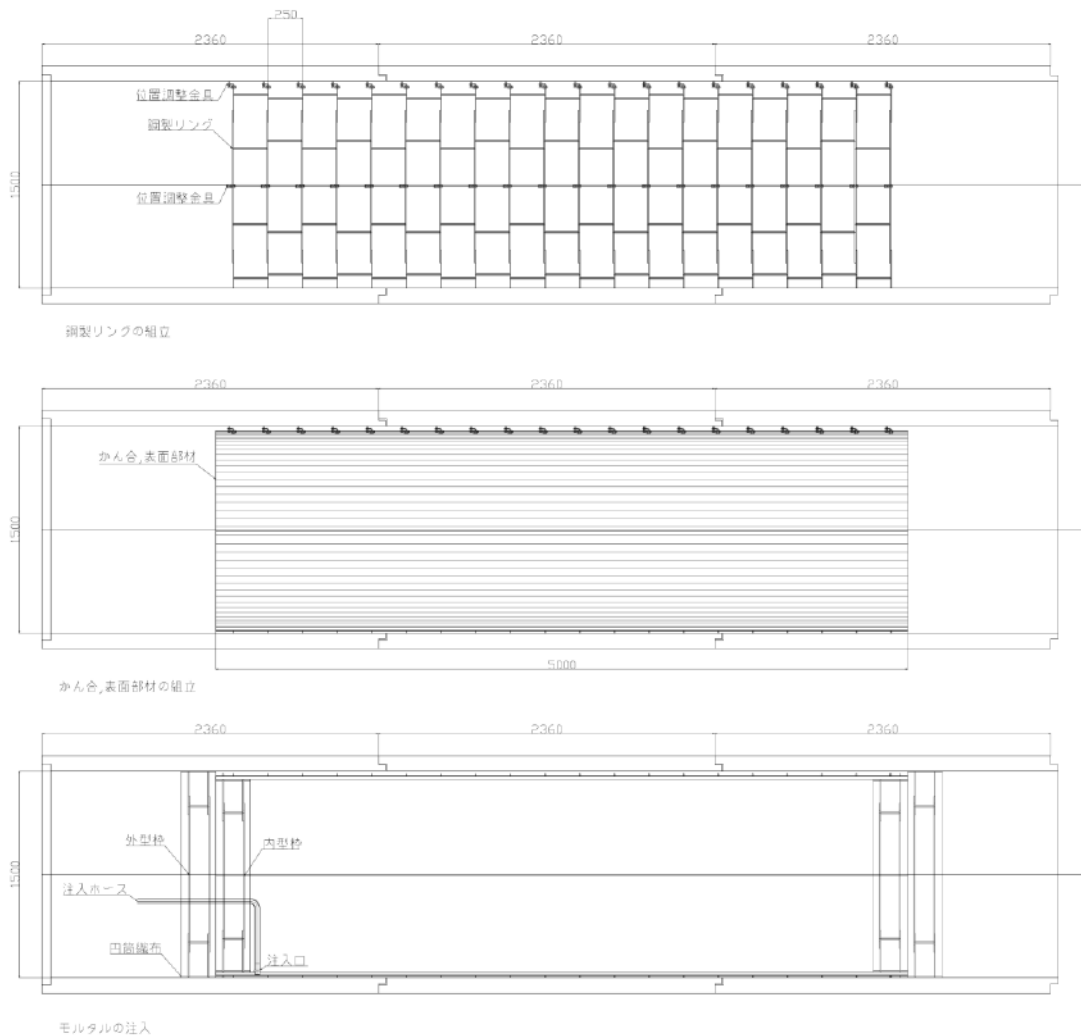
円形管の施工性試験の概略図（単位 mm）
